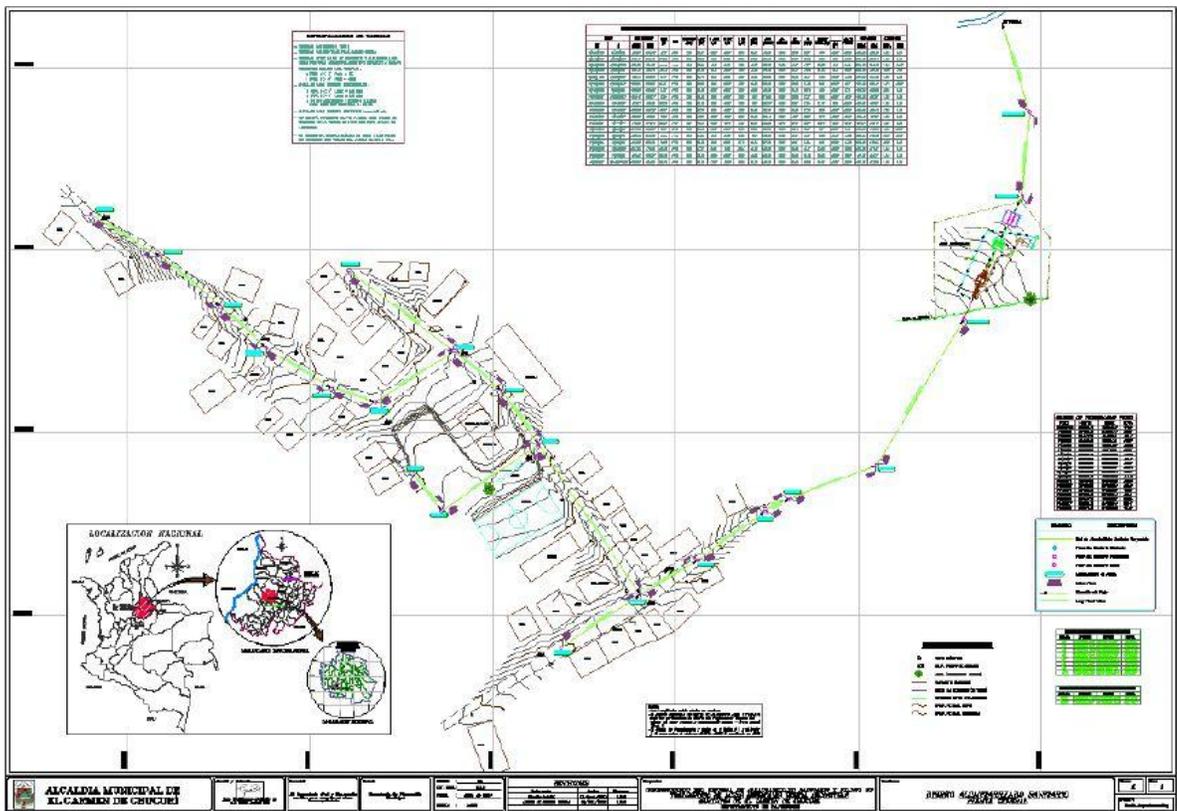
Plano de Diseño Alcantarillado Sanitario –Fuente: Informe Alcantarillado Sanitario Angosturas
